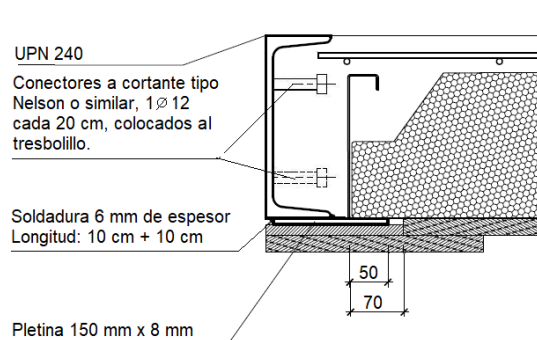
Apoyo lateral del forjado con el sistema SEST™ sobre perfil metálico.
